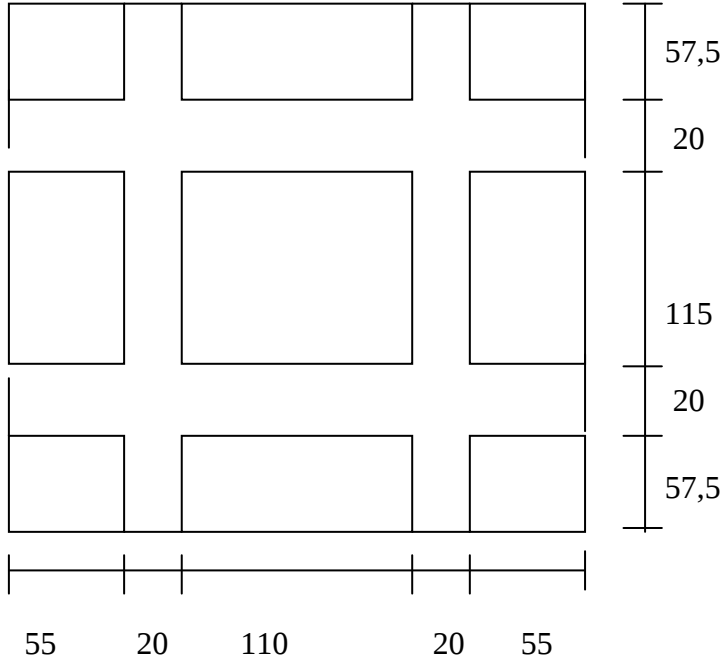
Kaset döşeme tipik plan ve kesiti
